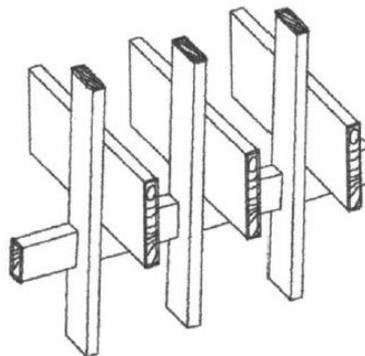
Sistema Balloon Frame - o detalhe do sistema de nós (FONTE: BERRIEL, 2009).
